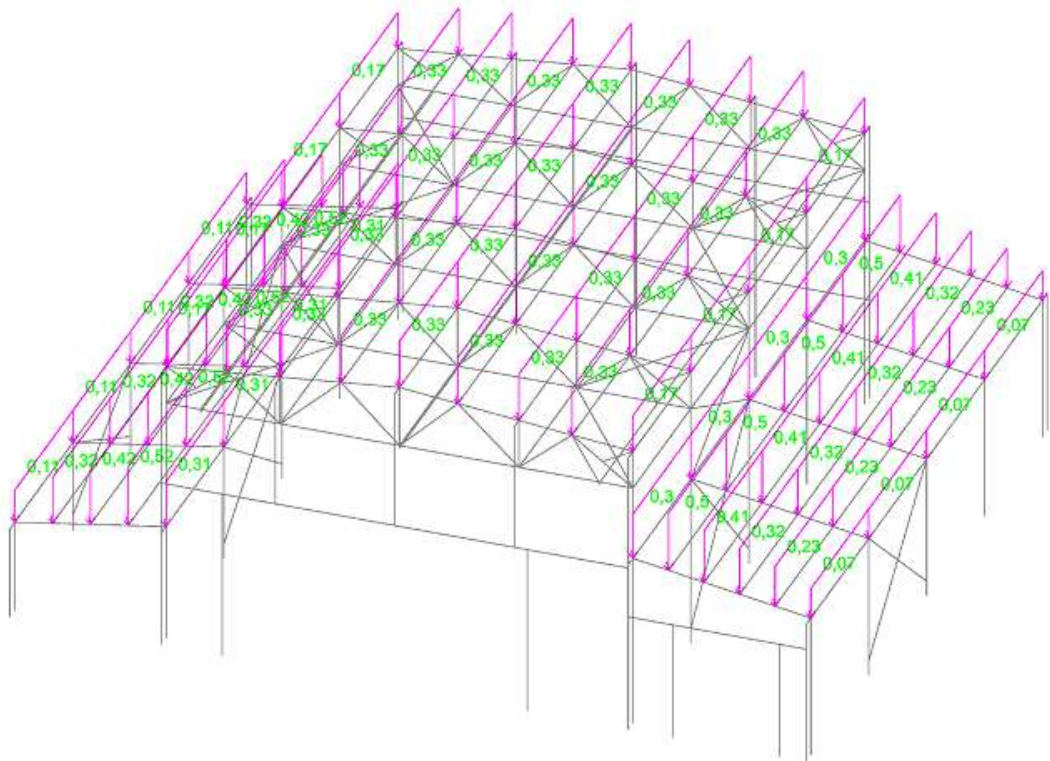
Схема загрузки снеговой нагрузкой
